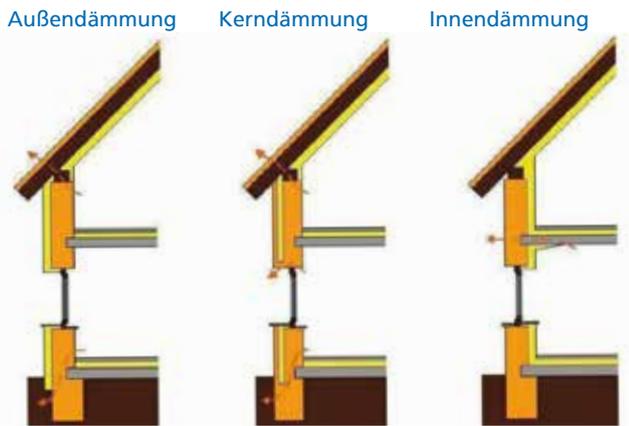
Dämmvarianten, Planungsbüro Bärbel Ebeling
